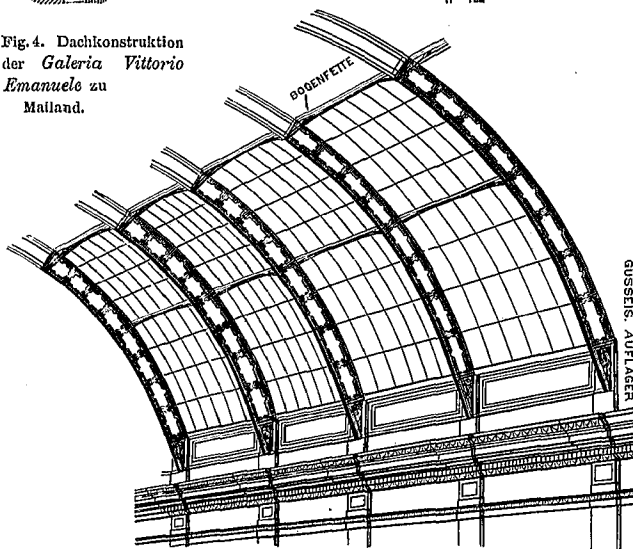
Dachkonstruktion der Galeria Vittorio Emanuele zu Mailand.
